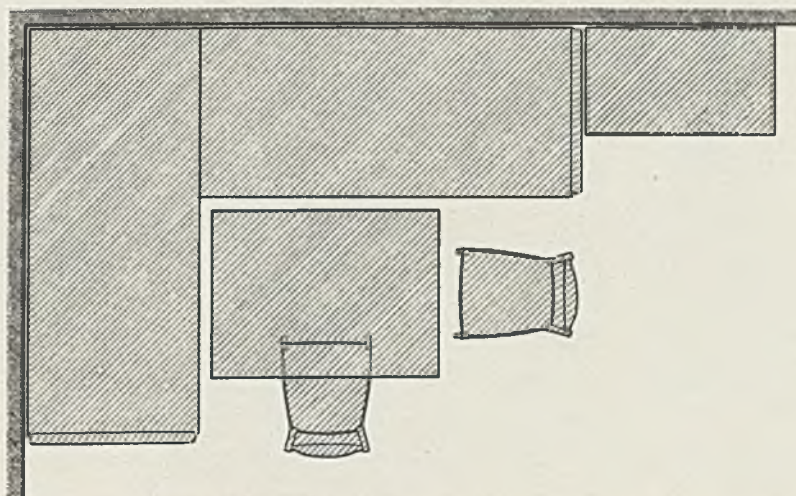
Grundriß der Sitzecke mit Bettkommode daneben
